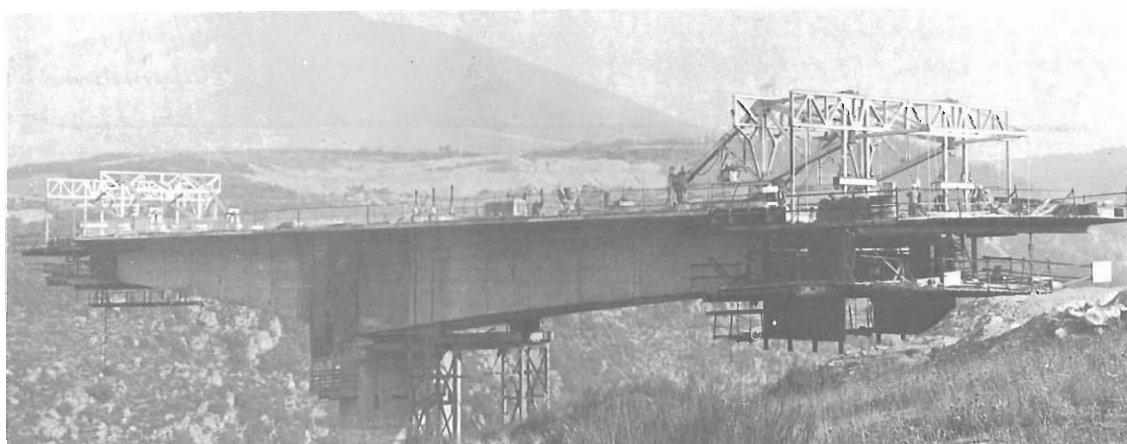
Puente del azufre. Vista del puente durante la construcción.
